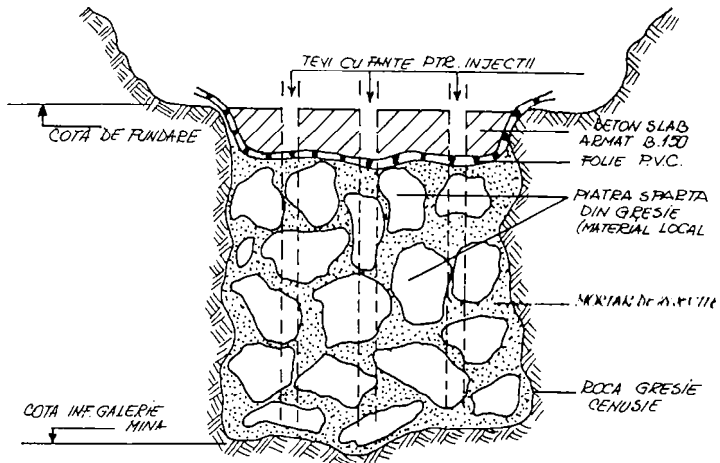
SECȚIUNE TRANSVERSALĂ - GALERIE MINIERĂ UMPLUTĂ CU BETON INJECTAT.
